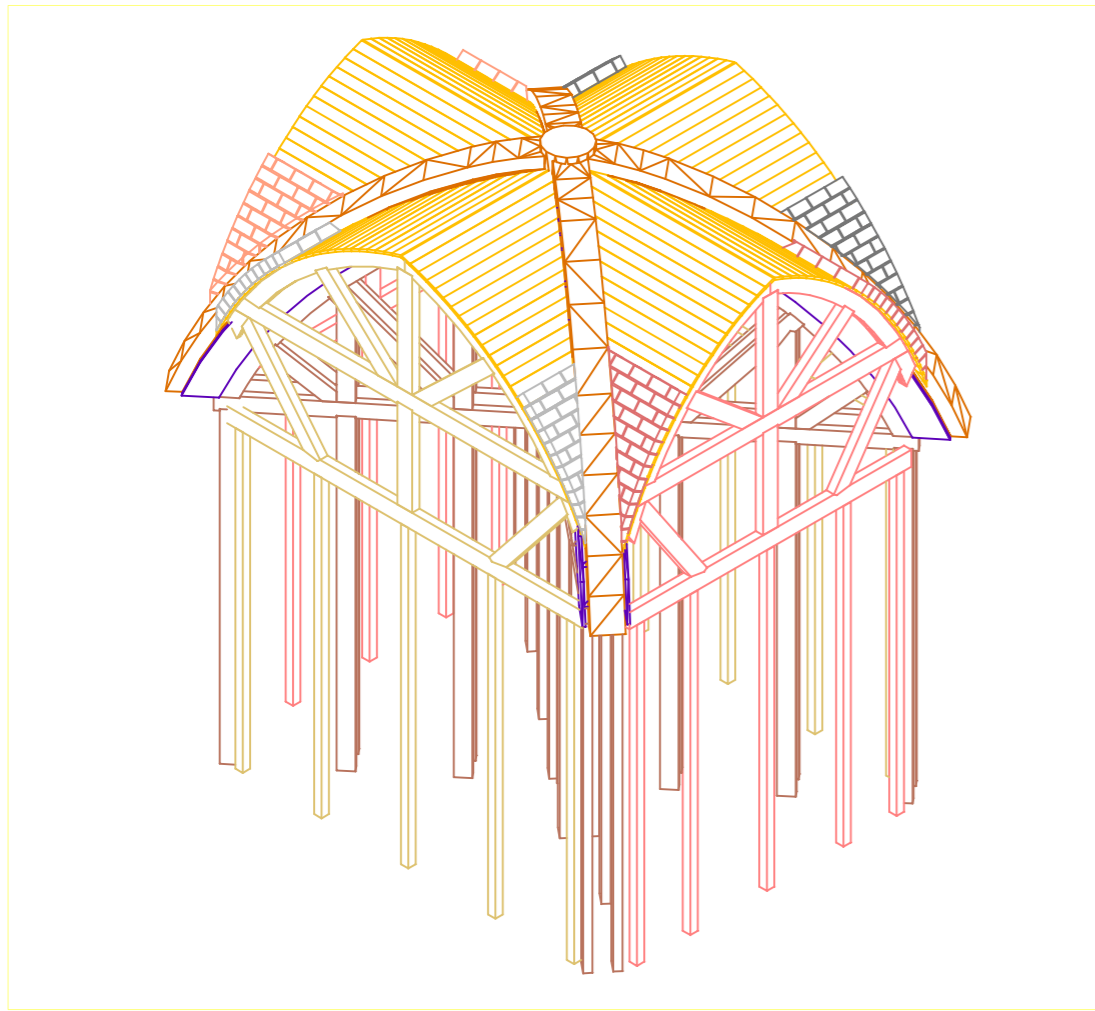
PRIMEIRA FASE DE RECONSTRUÇÃO
